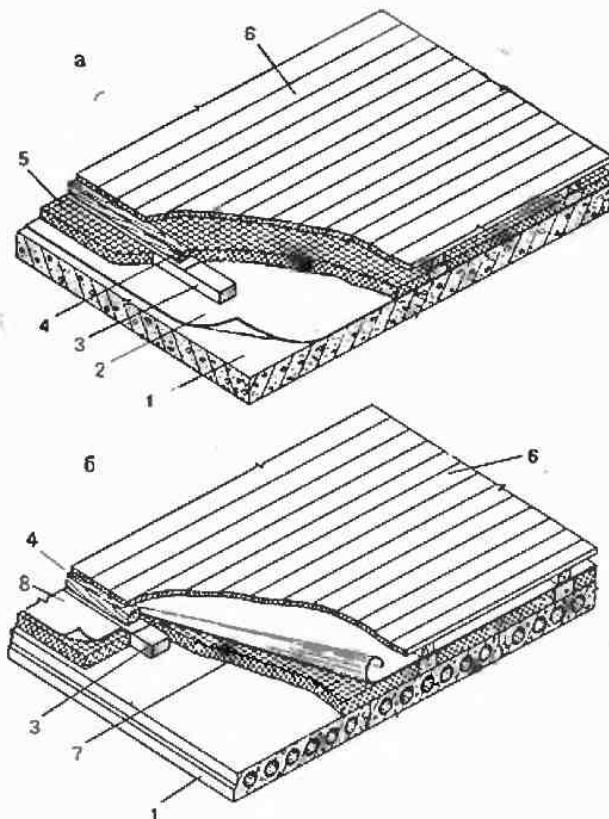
Перекрытия над котельными и неотапливаемыми помещениями:
